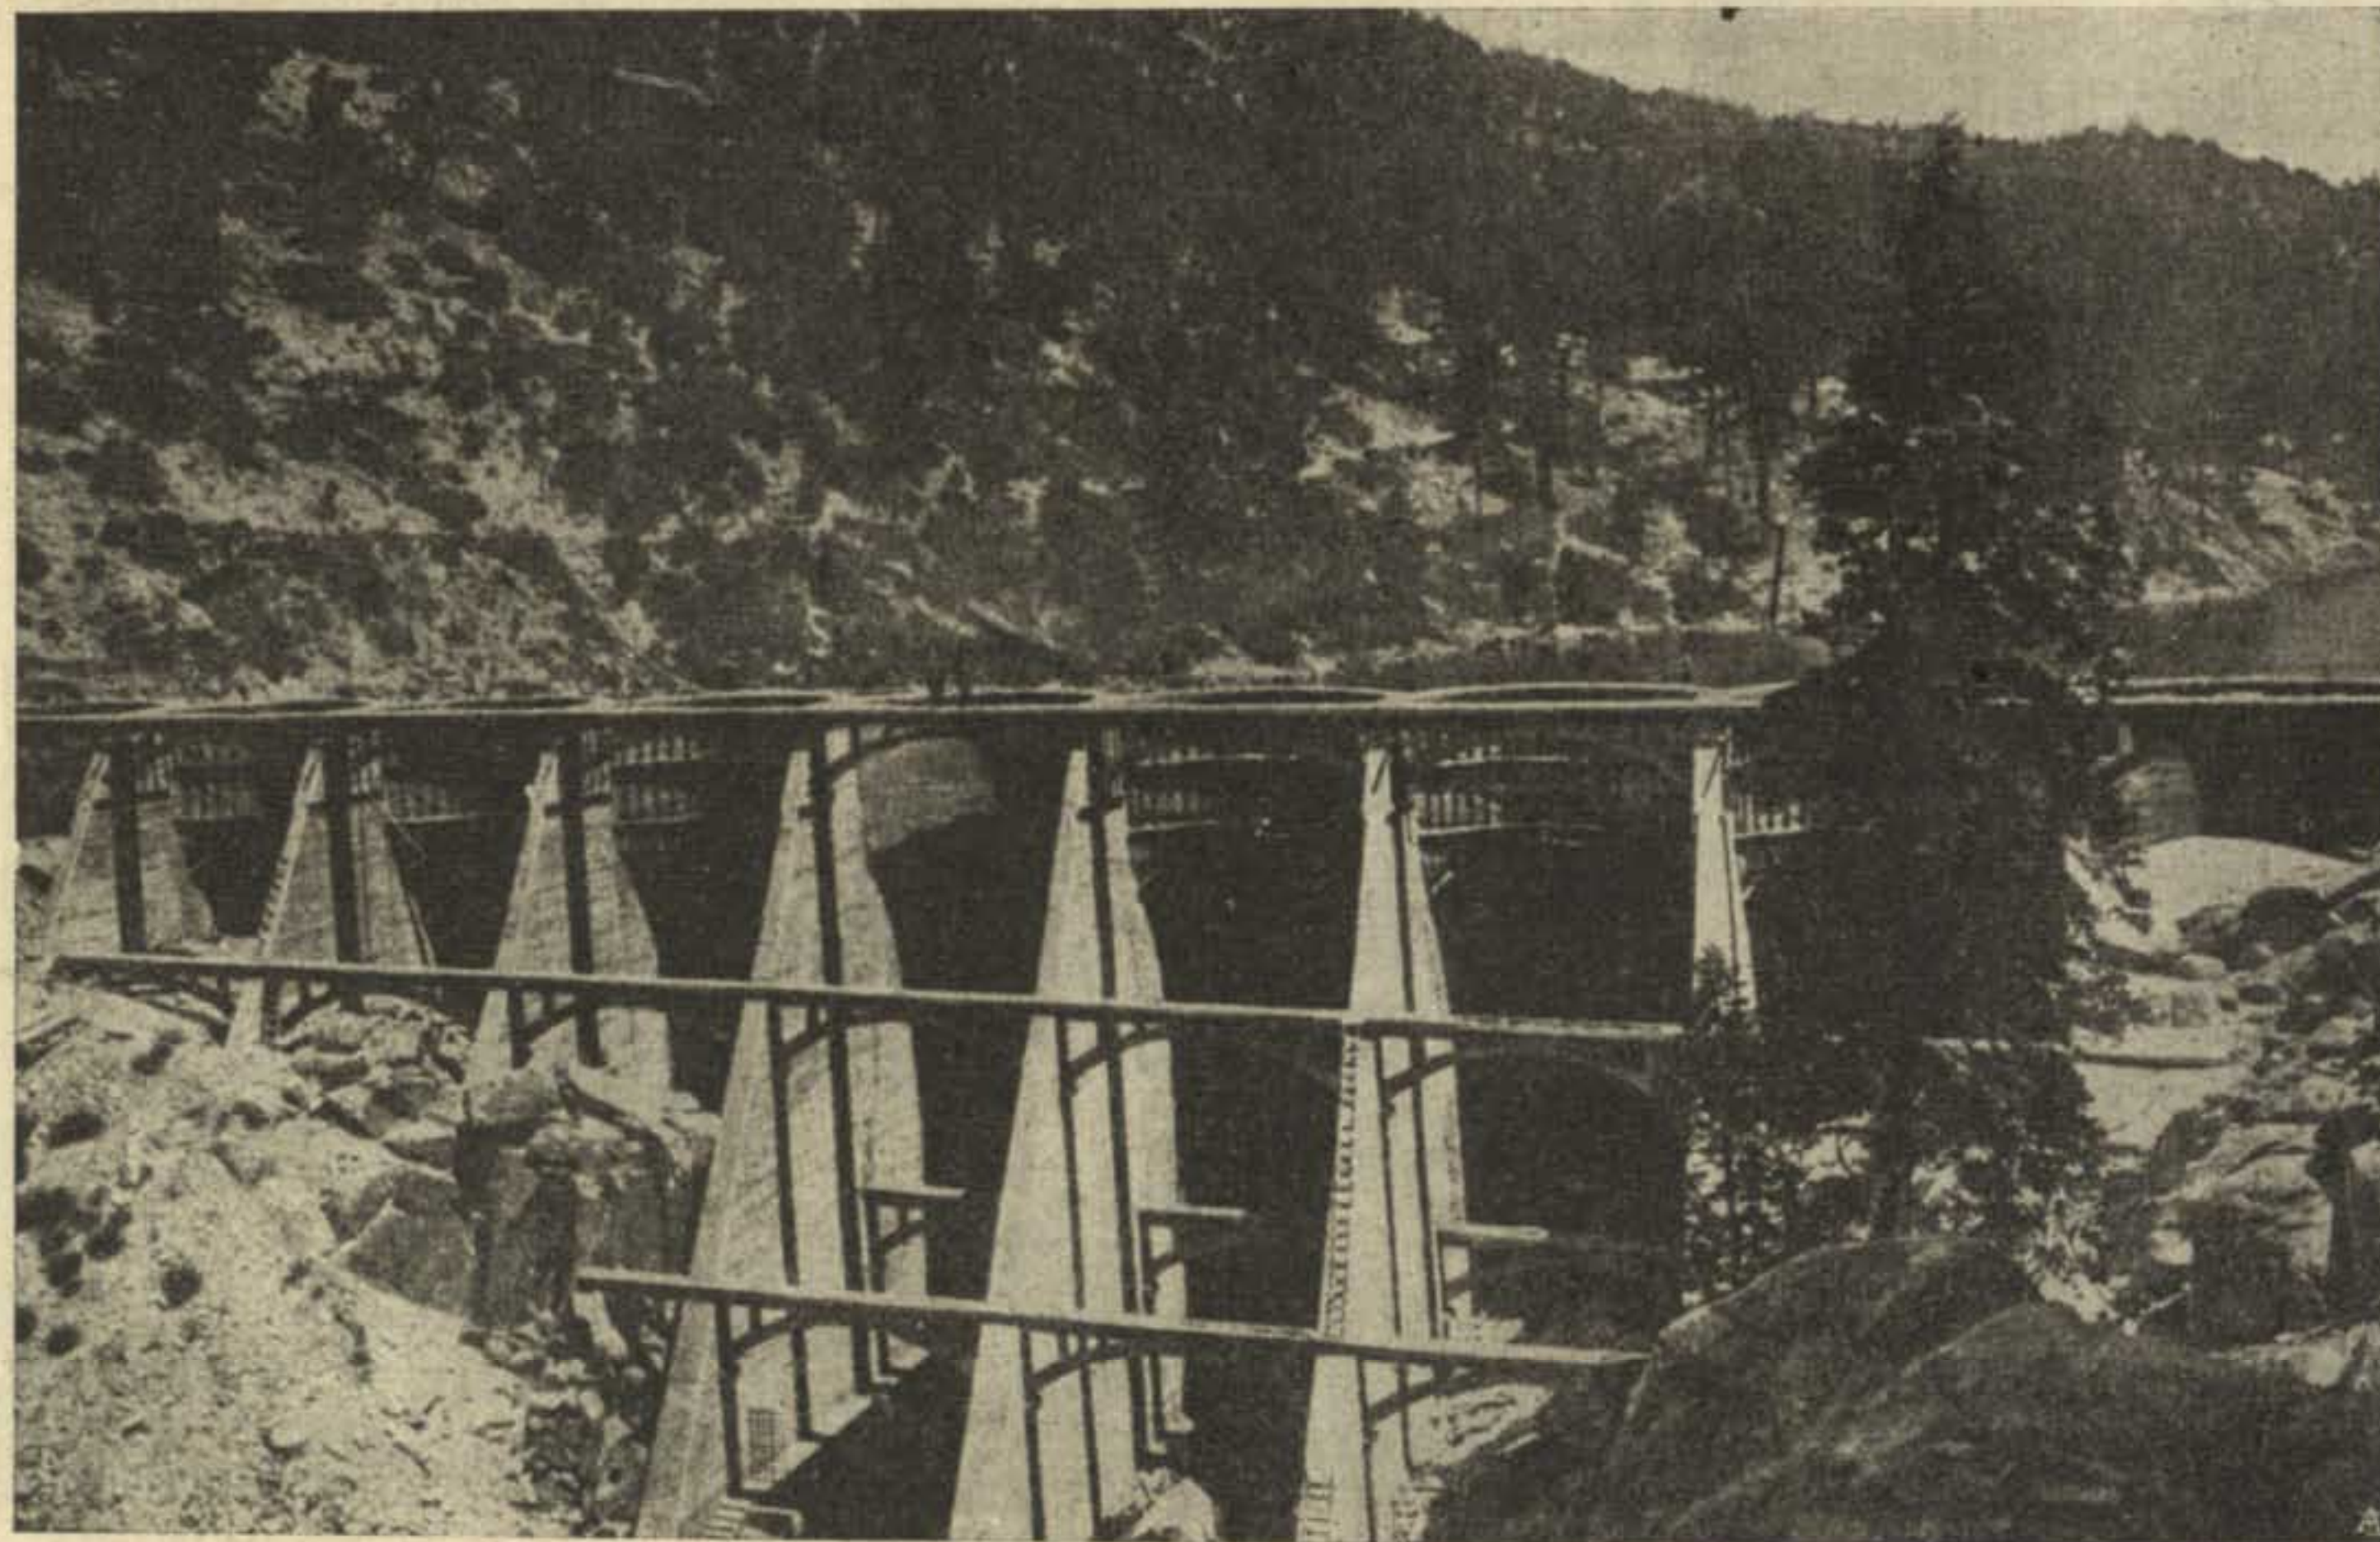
Diga ad archi multipli di Big Bear Valley, California. (Vista da valle, a lago pieno: si vedono i pilastri di appoggio degli archi e le travi di controventamento dei pilastri).
